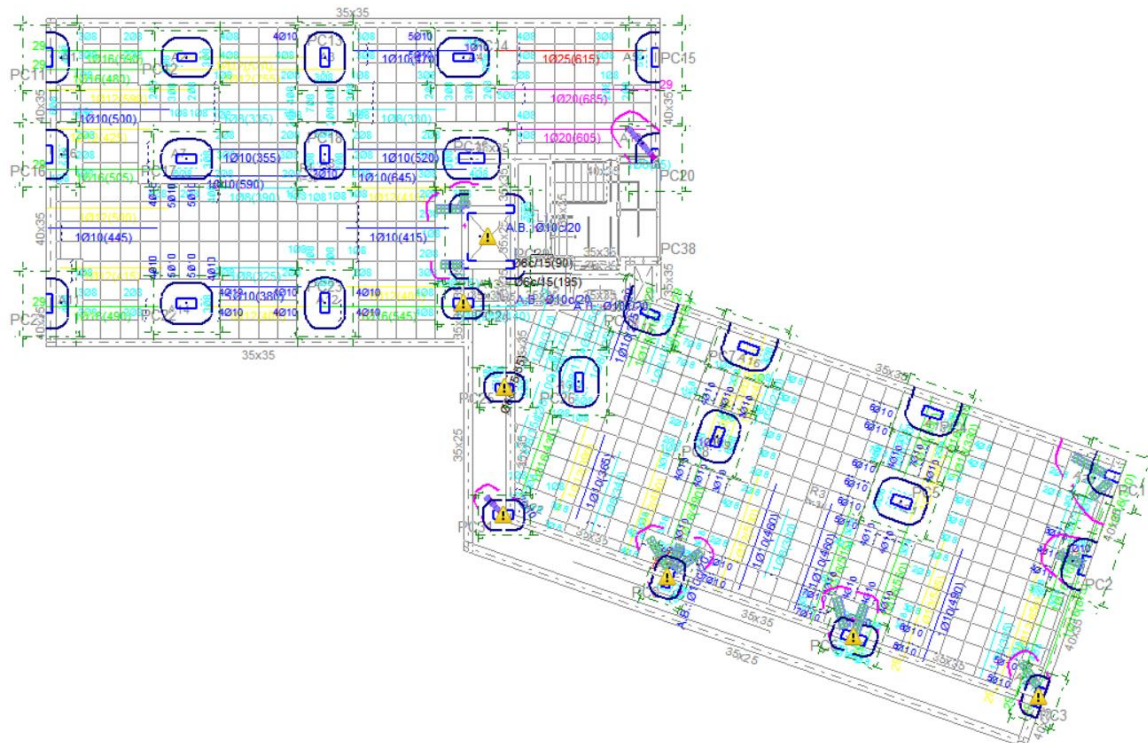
Punzonamiento Planta Segunda, Módulo C
